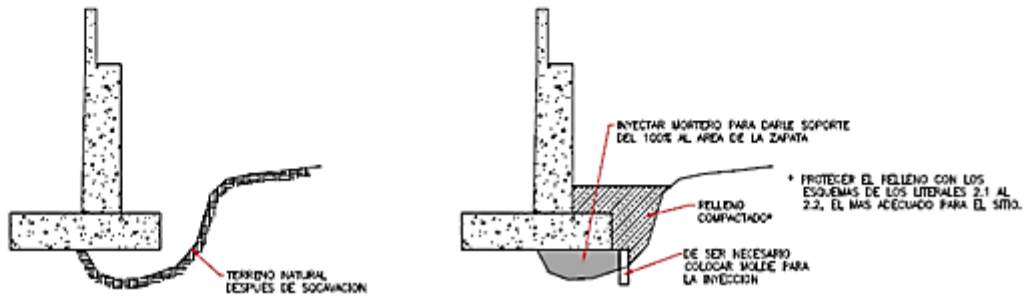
Propuesta de reparación en pilas y estribos de fundación directa.
